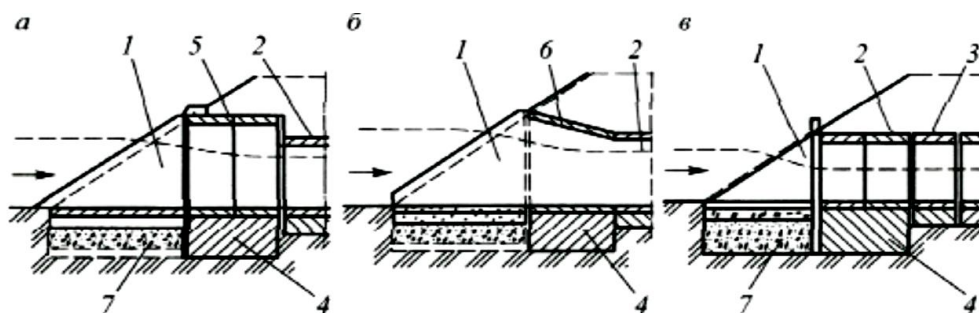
Трубы с различной конструкцией входного звена:
